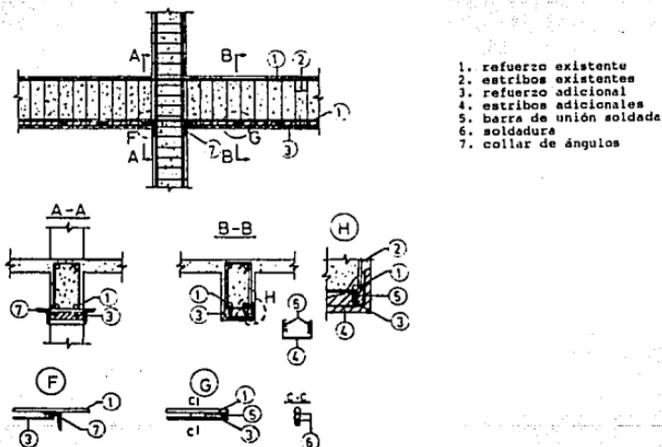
Encamisado de concreto reforzado por flexión.
